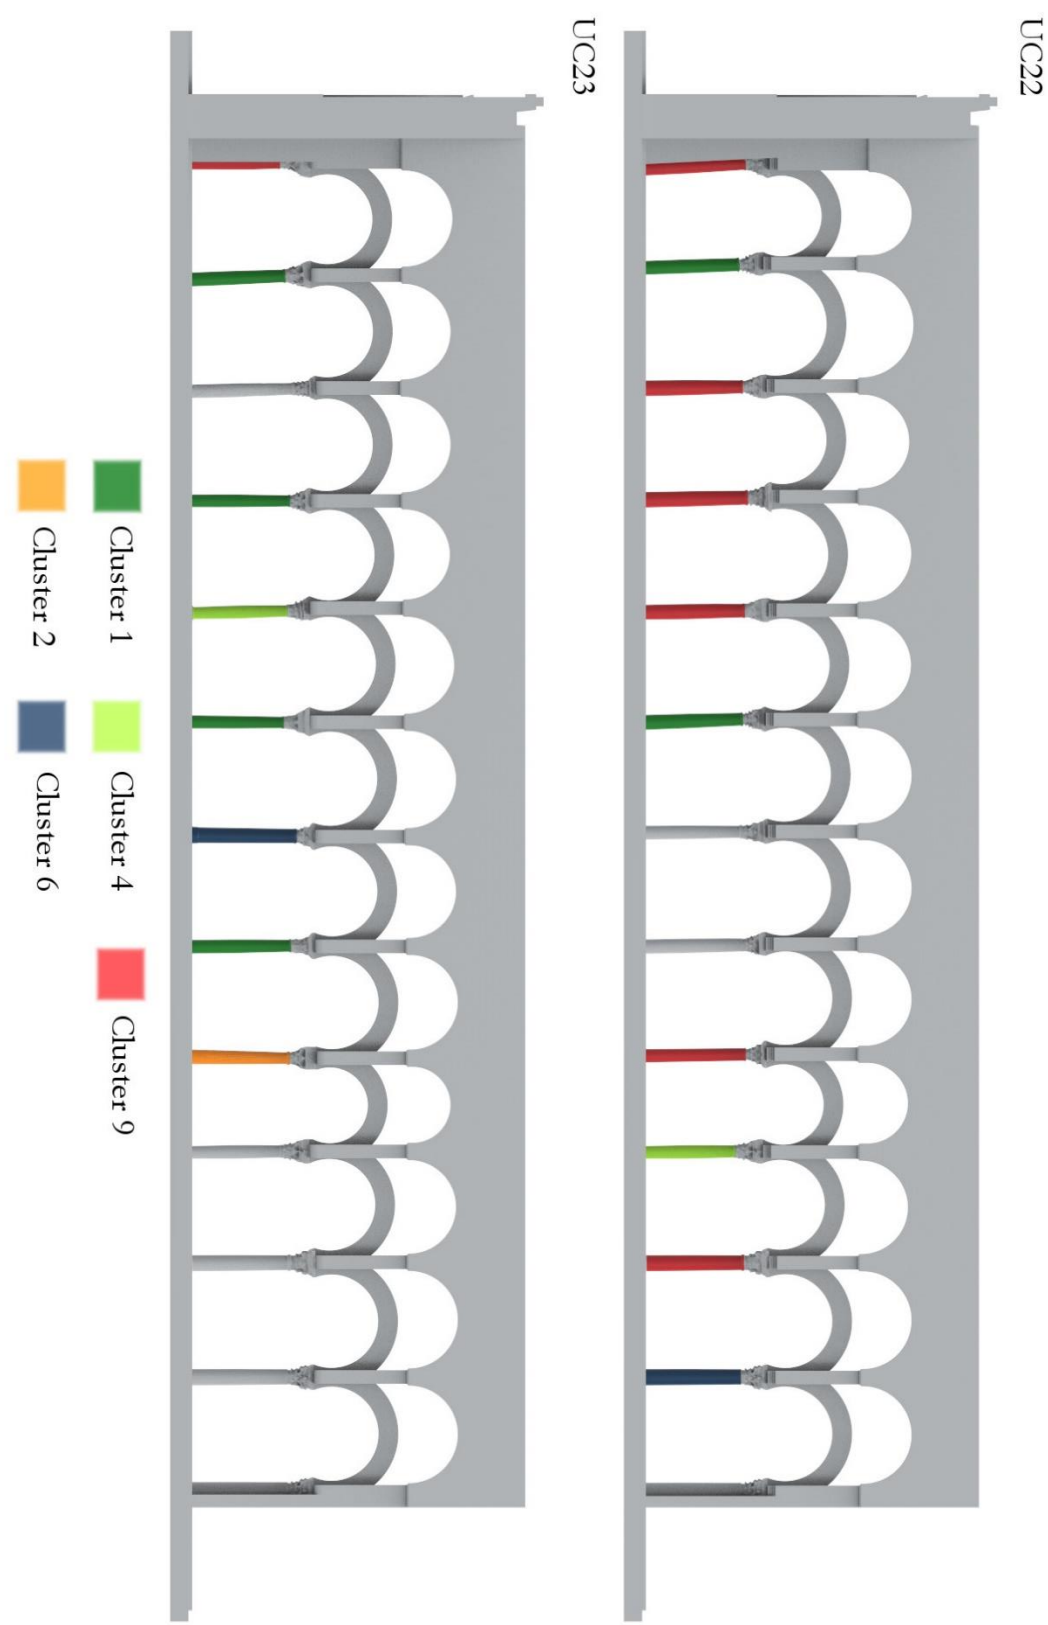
Alzado de las Unidades Constructivas (UC22-UC23) con los Clúster de los Fustes.
